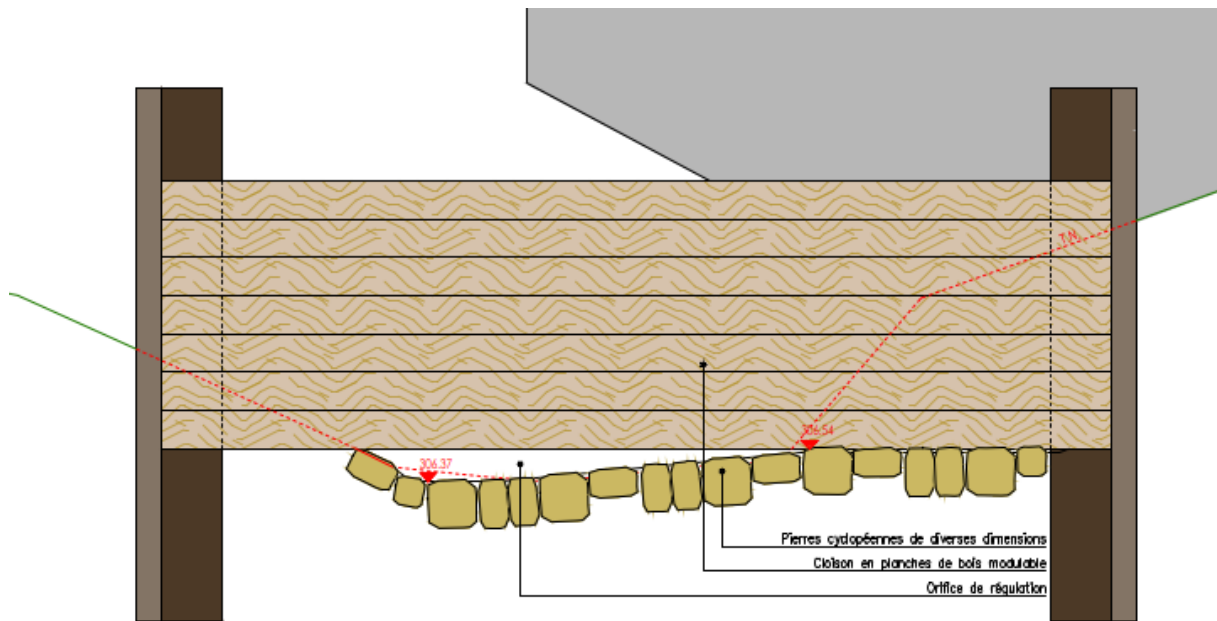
Auszug aus dem veralteten Plan „Concept d'assainissement - Vues en plan et coupes ouvrages“ (Quelle: Luxplan S.A. Stand 06/2020): Querschnitt durch die Ausleitung (Schnitt CC, vgl. Abb. 24)
